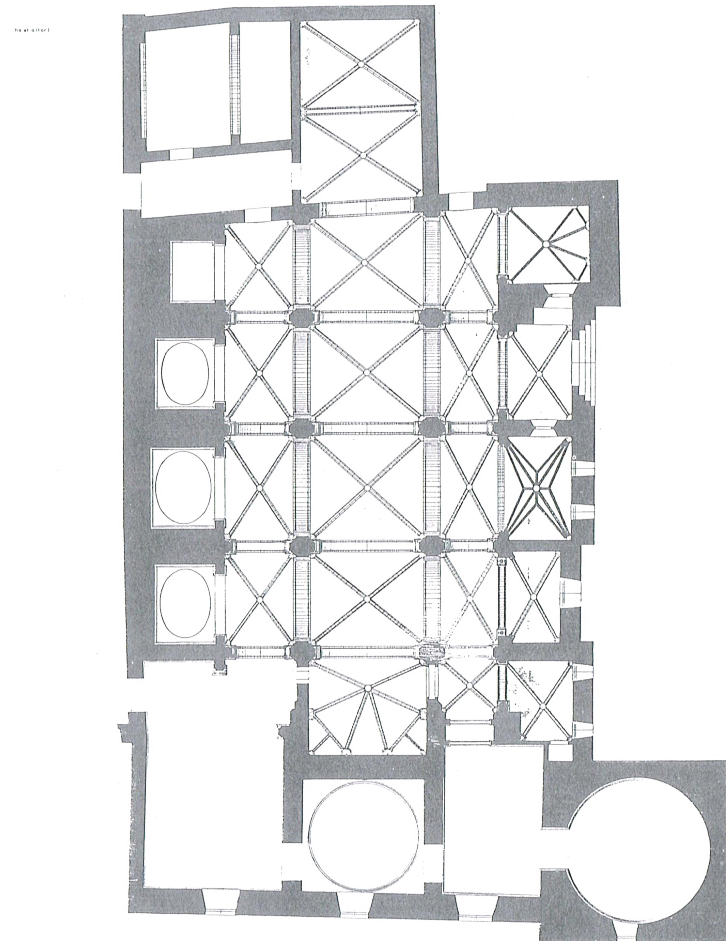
Planta de la iglesia de Santa María de El Puig.
